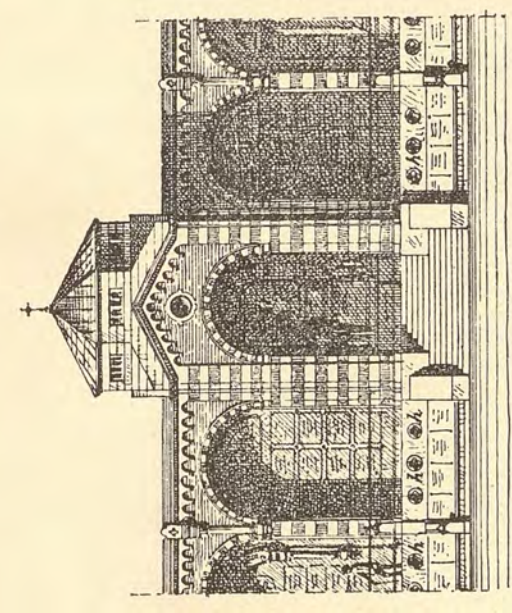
Prospetto della muratura, suo attacco coll'edicola terminale della facciata principale e sezione dei portici attuali.
